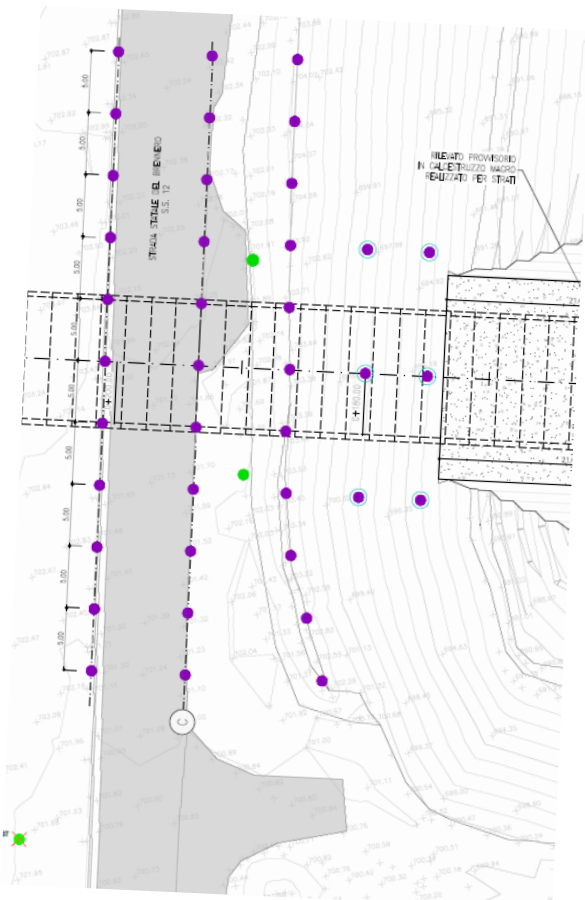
Monitoraggio SS12 Finestra di Forch – stralcio planimetrico tavole del monitoraggio e vista area
